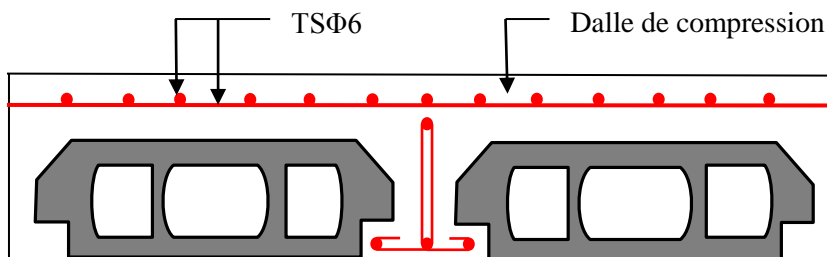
Schéma de ferrailage de la dalle de compression.
